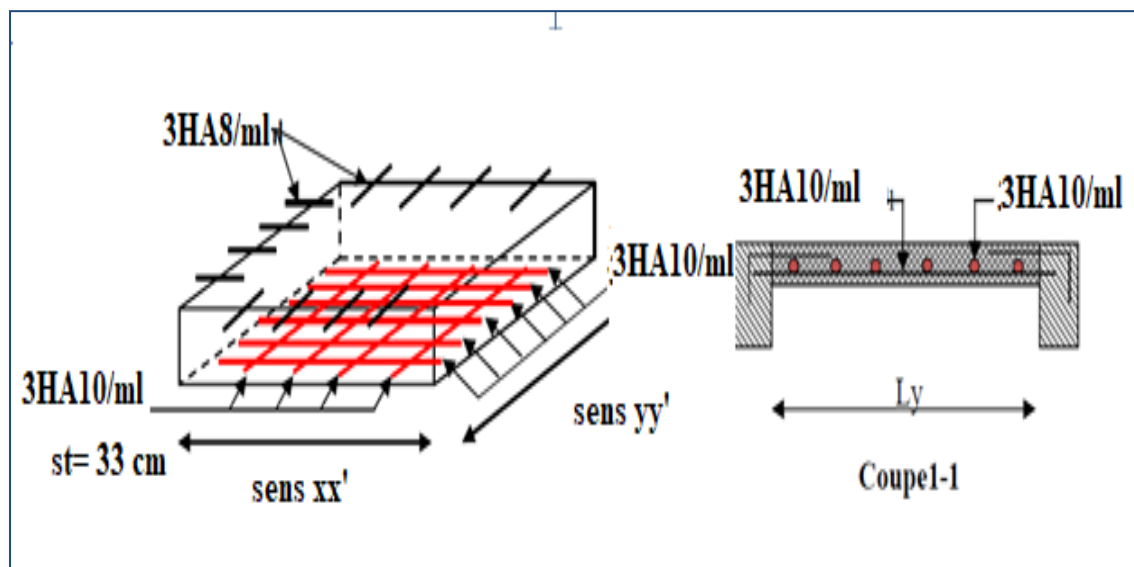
Schéma de ferrailage du balcon de l'étage courant.
